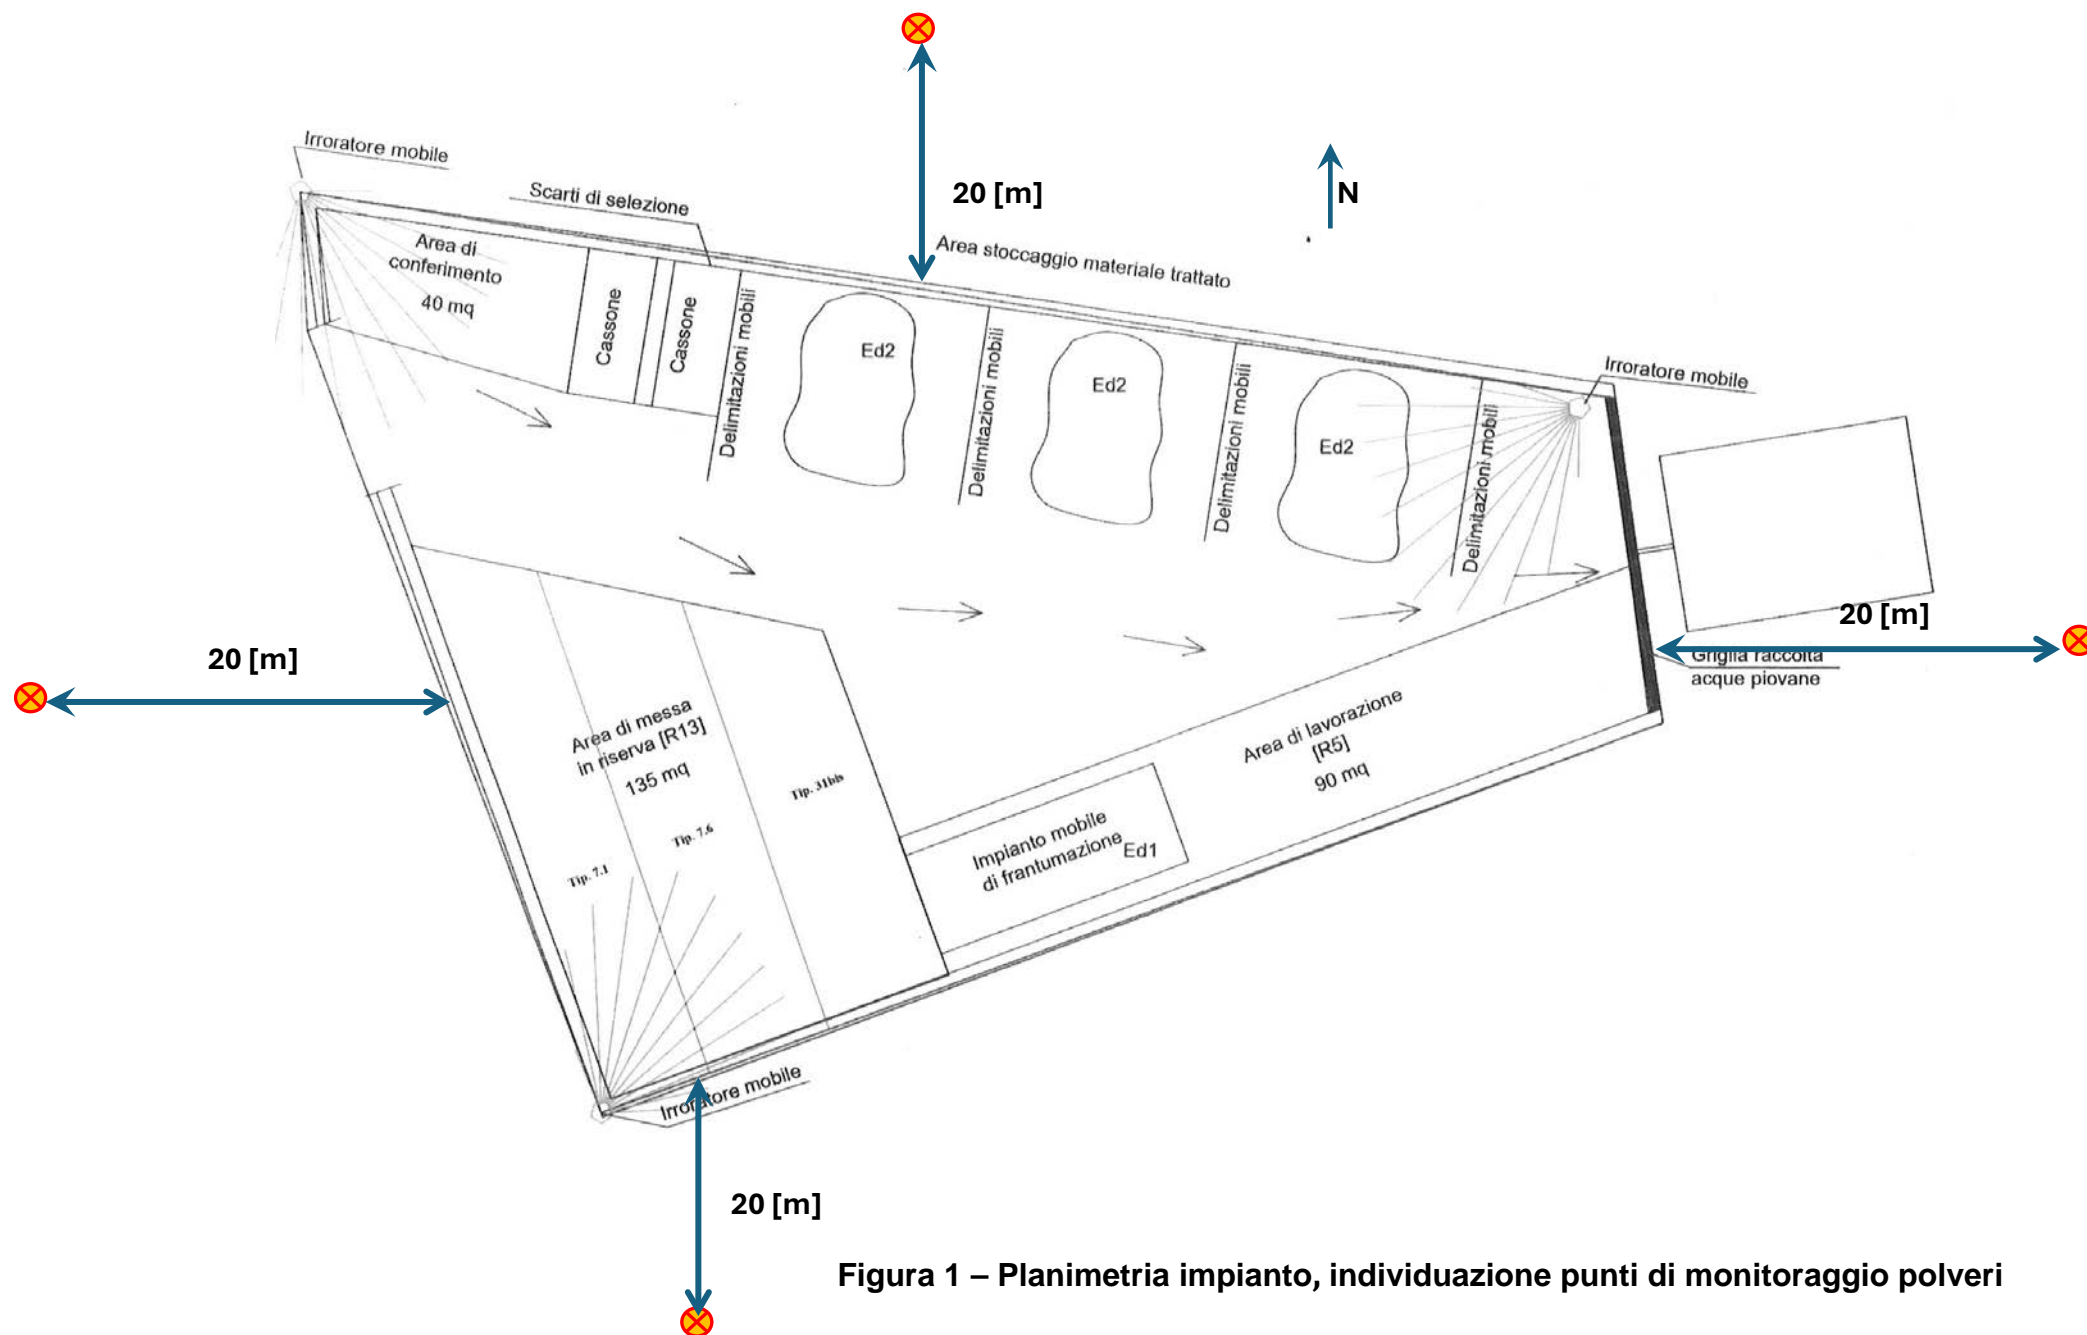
Planimetria impianto, individuazione punti di monitoraggio polveri
